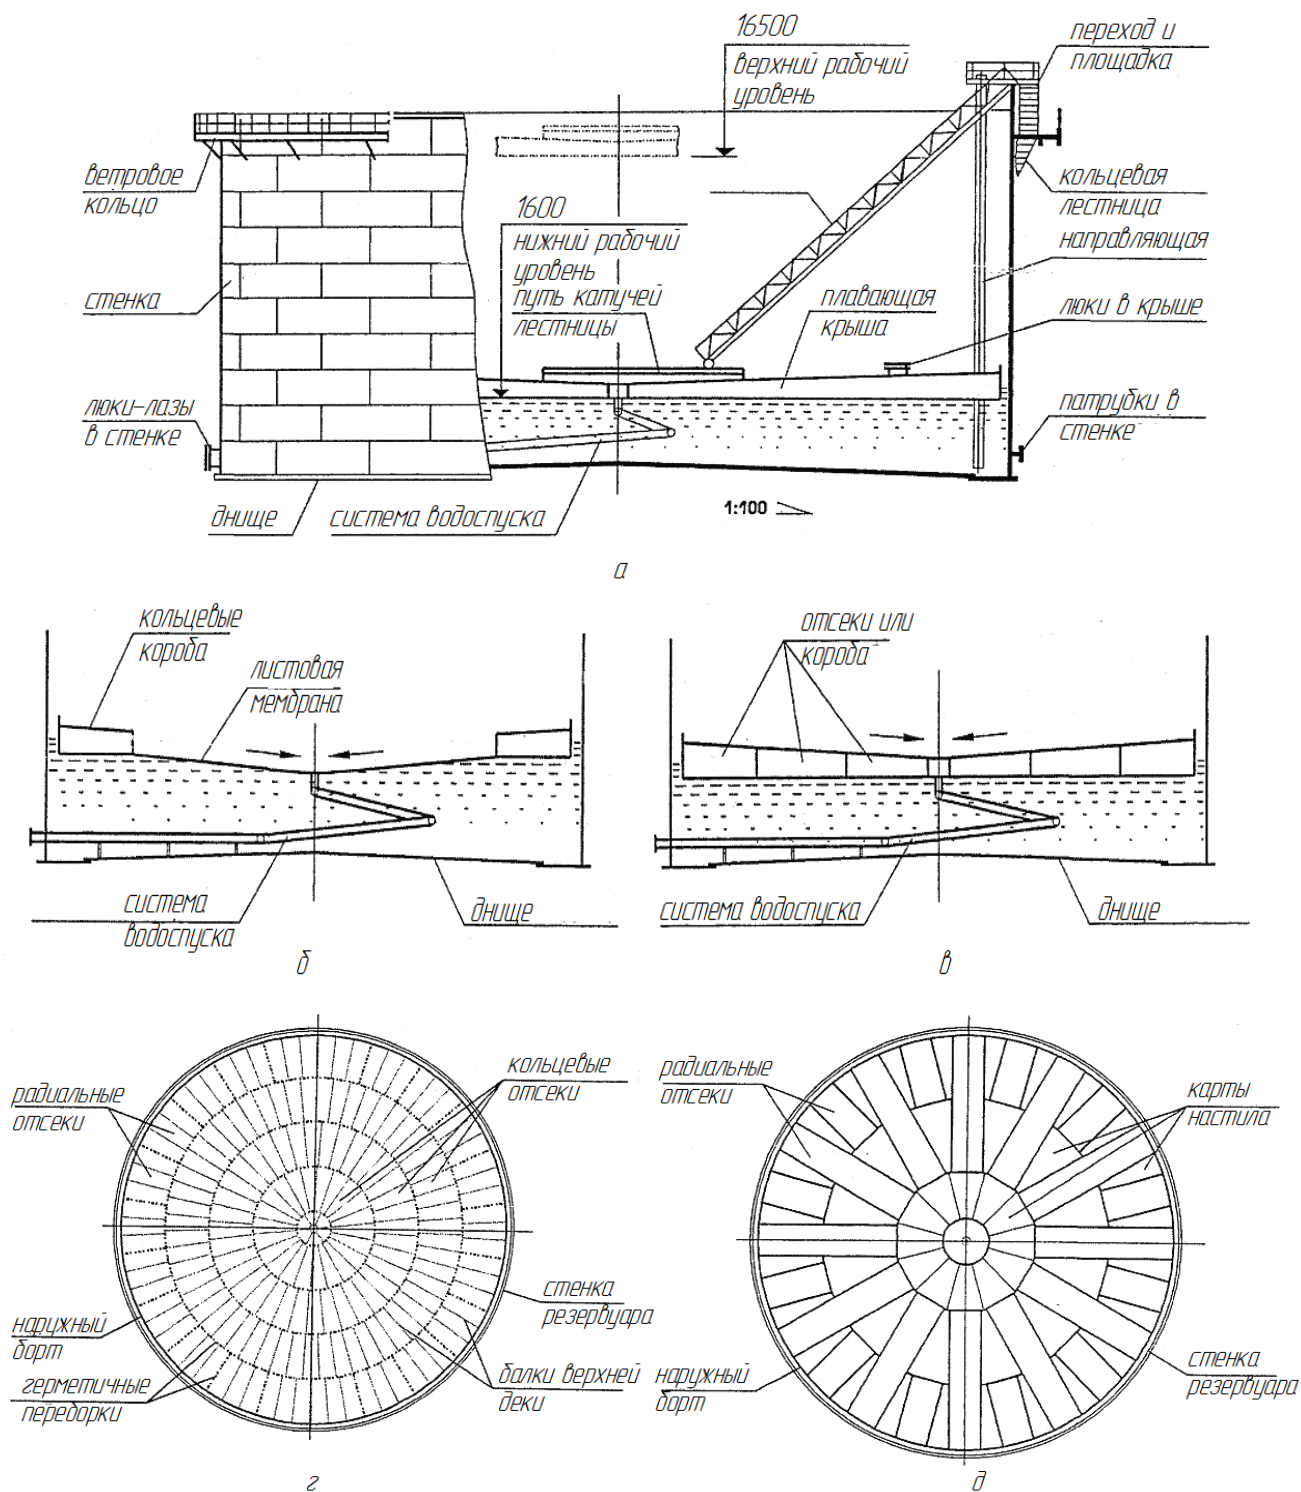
Цилиндрический РВС с плавающей крышей
